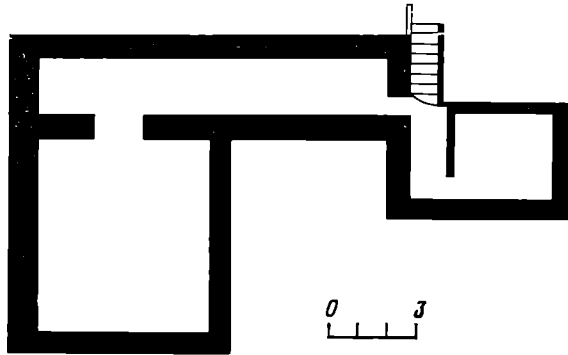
План подвального этажа дома IV—III вв. до н. э.
